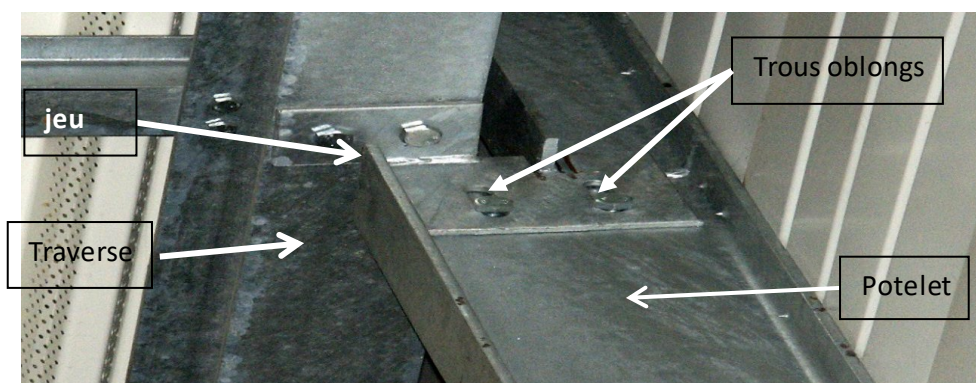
dispositif d'appui glissant du potelet sur la poutre auvent (la traverse en fait partie)
